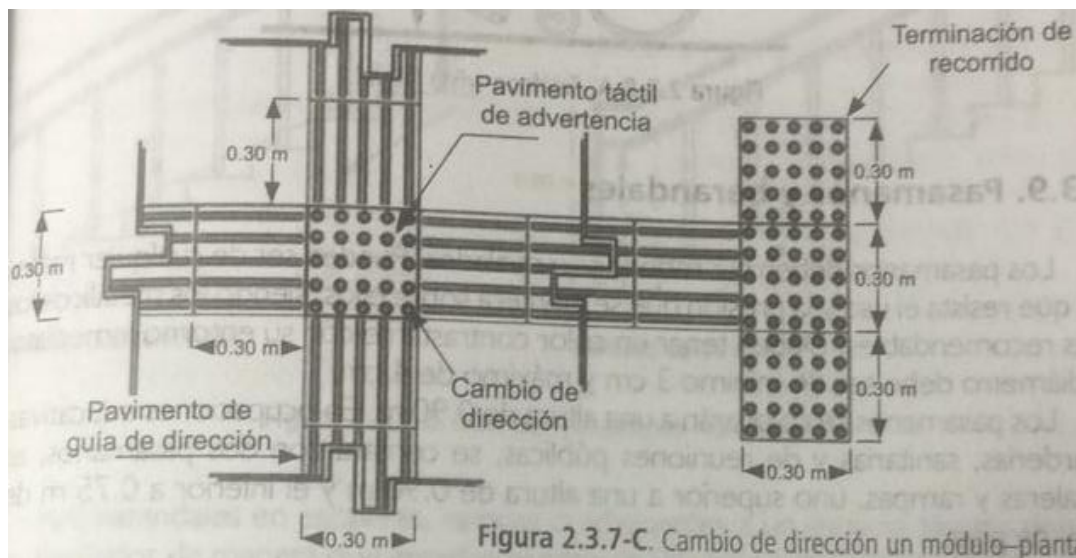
Ejemplo de guía con cambio de dirección un módulo visto en planta (Fuente: Reglamento de construcción del Distrito Federal, 2017)
